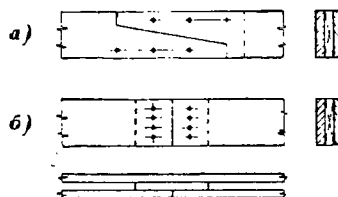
Стык нижнего пояса балки (к фиг. 9)
